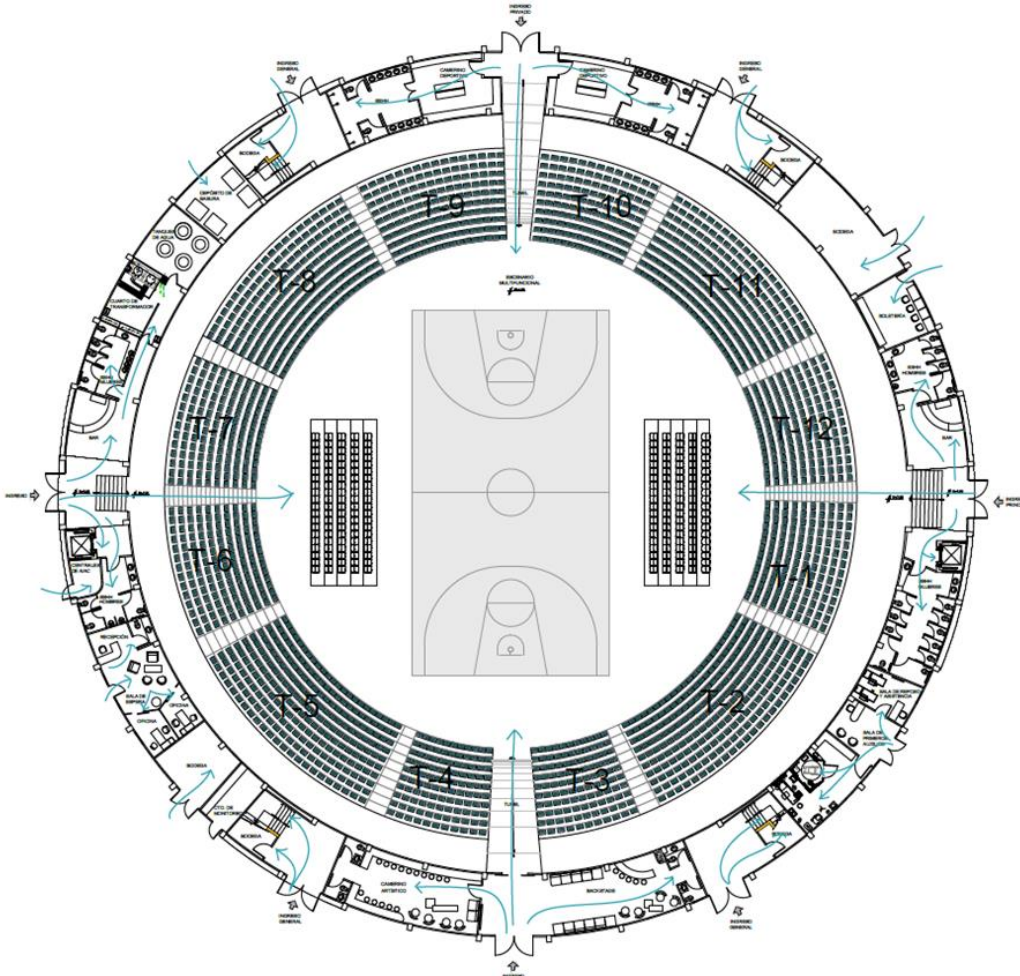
Circulación interior en planta baja. Fuente: Elaboración propia (2019).
